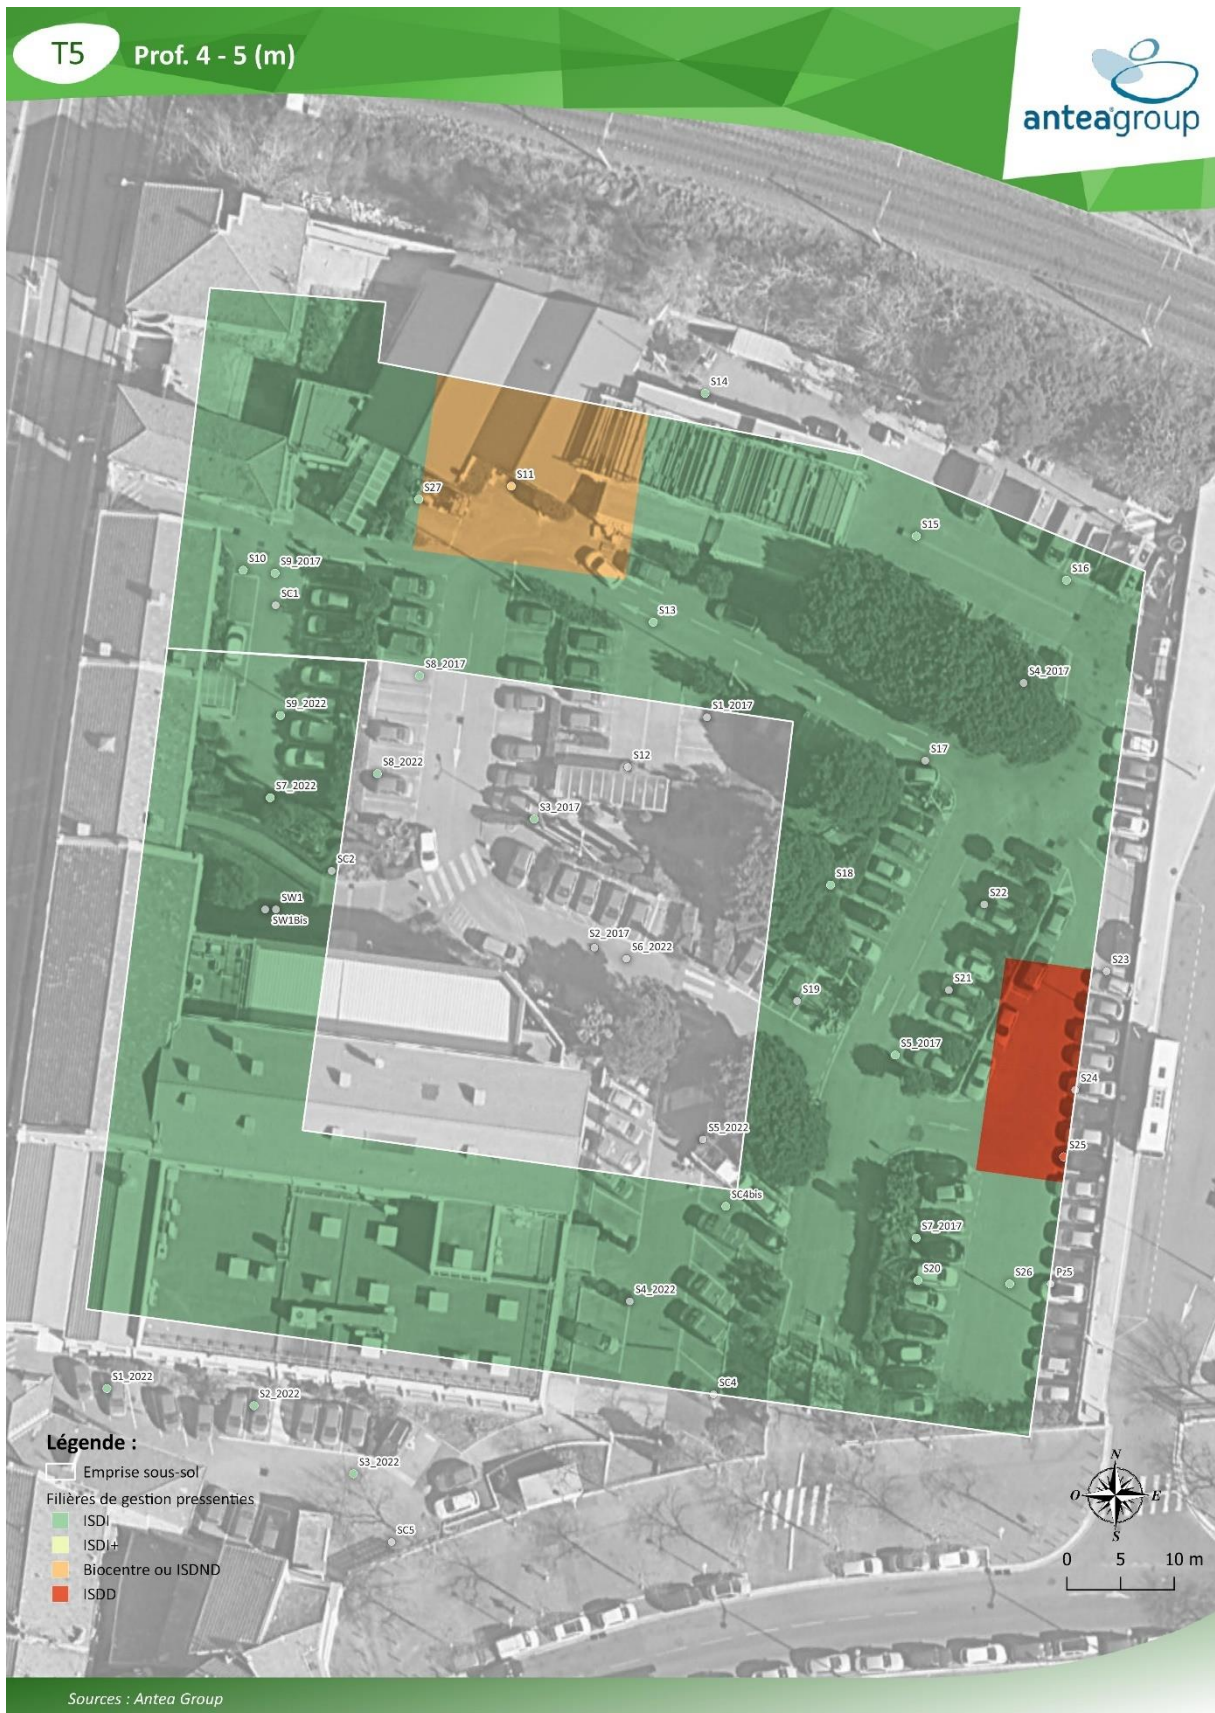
Plans de terrassement des sous-sols par tranche de 1 m
